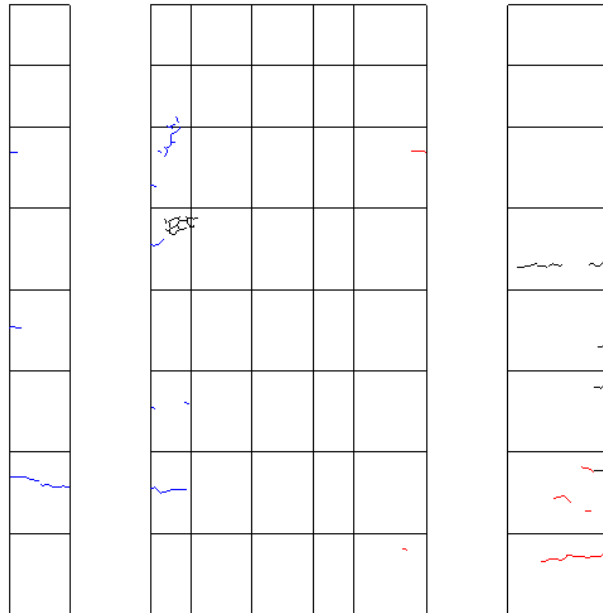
R=1/800 ひび割れ図
